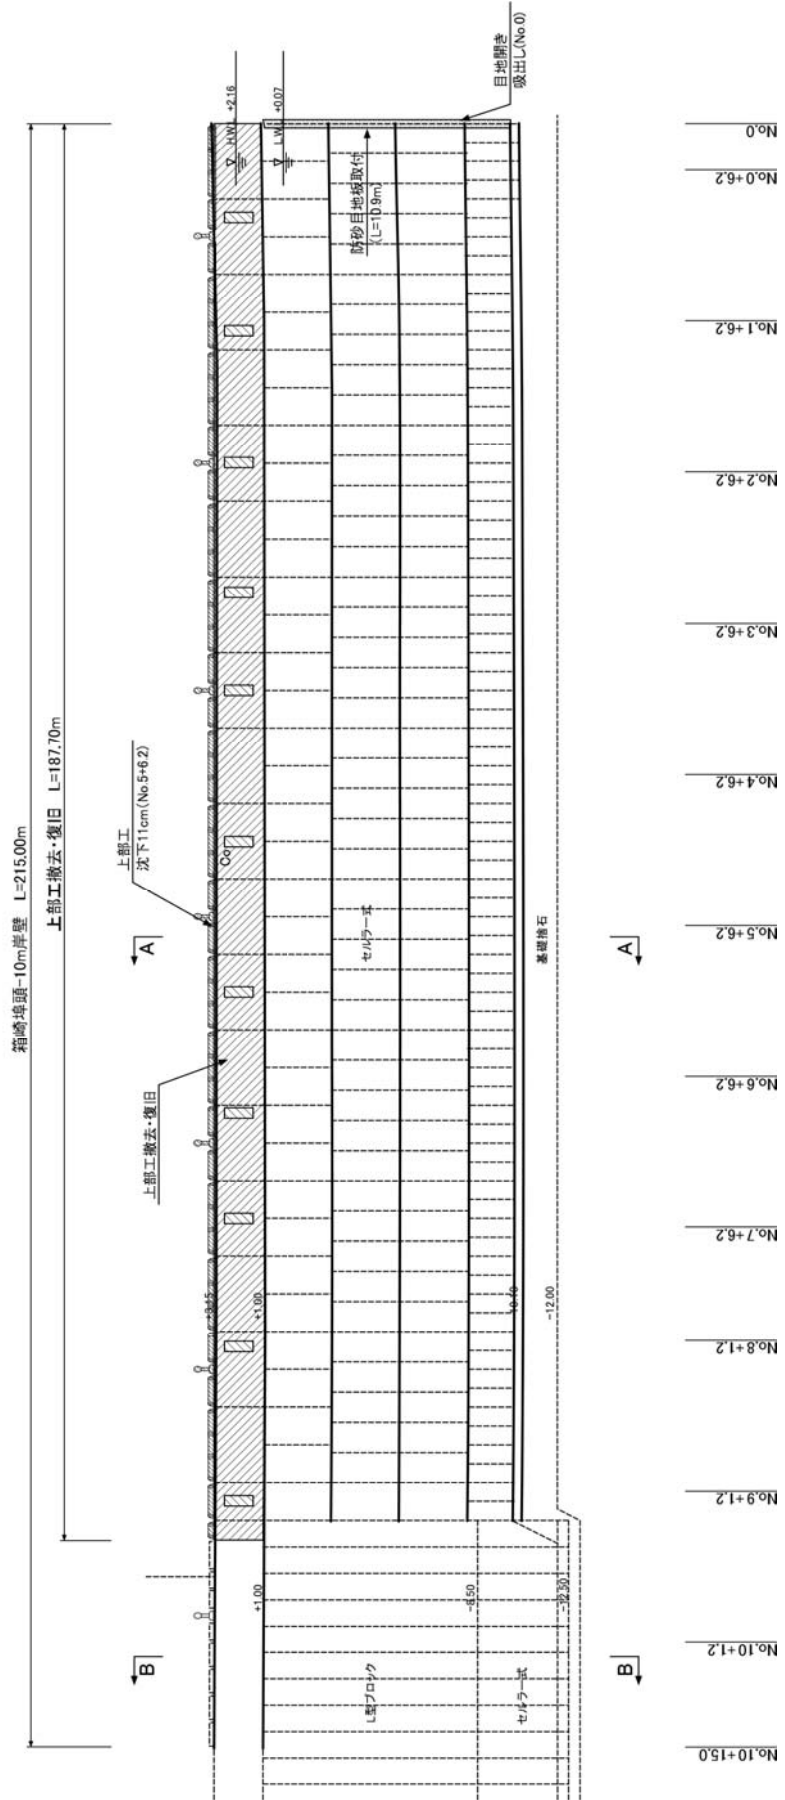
箱崎埠頭-10m 岸壁の被災・復旧平面図
